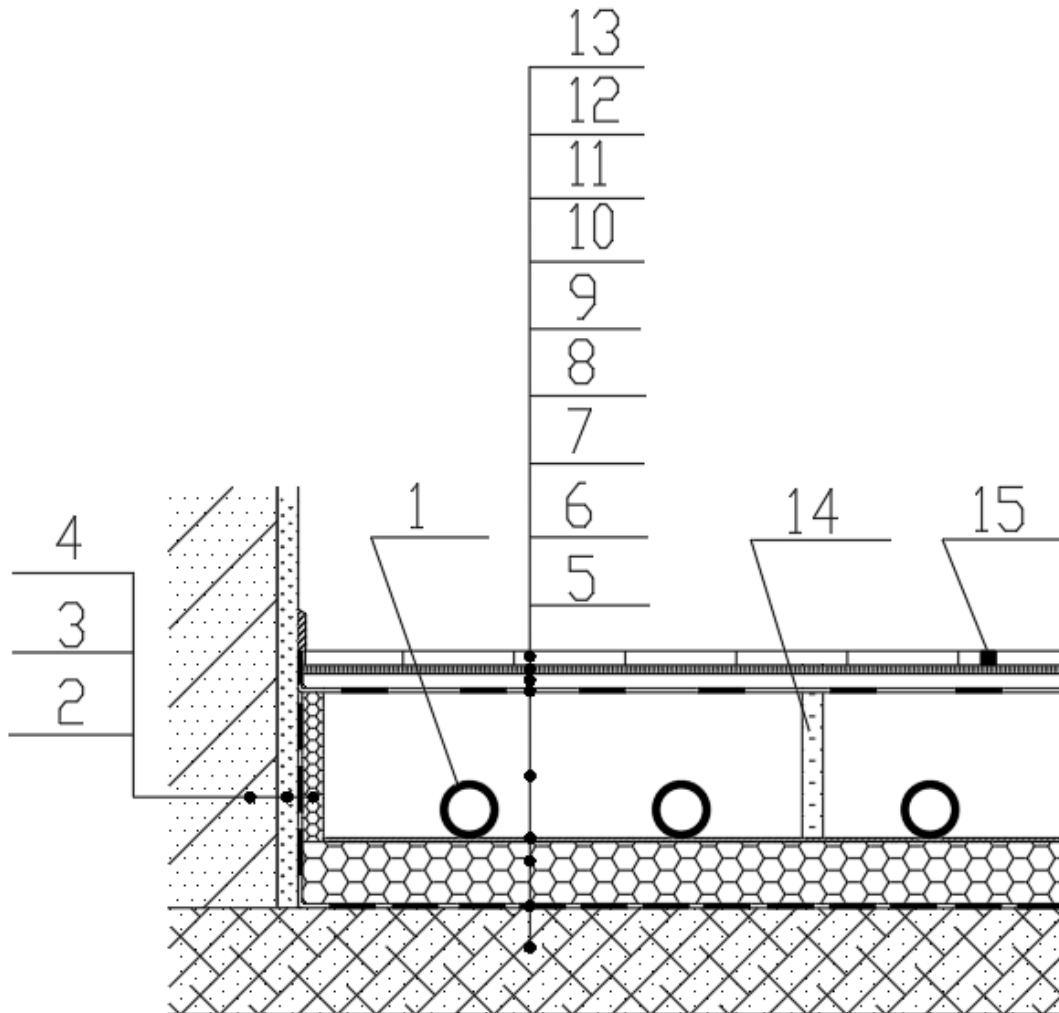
采用泡沫塑料板绝热层的混凝土填充式热水地暖地面构造
